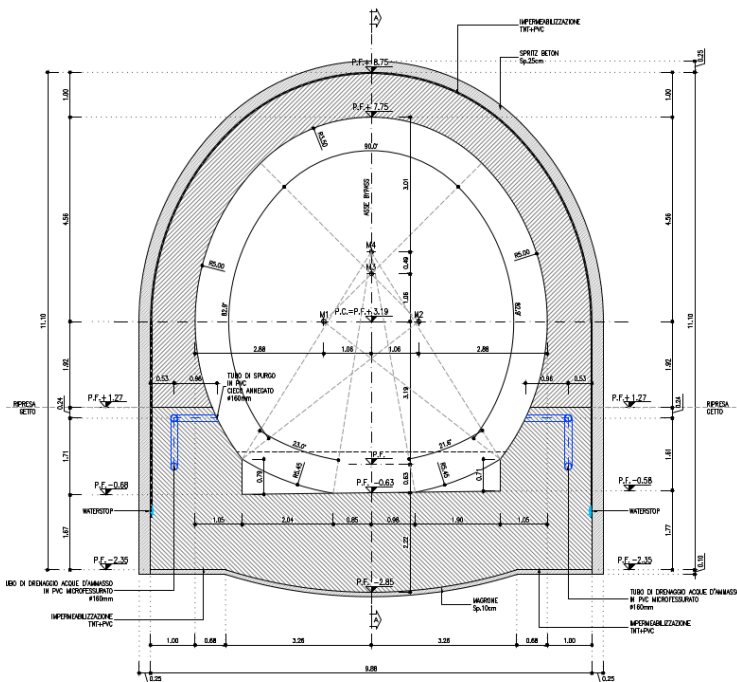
Carpenteria sezione innesto (IBOU1BEZZWBGNO400009) – sezione B-B
